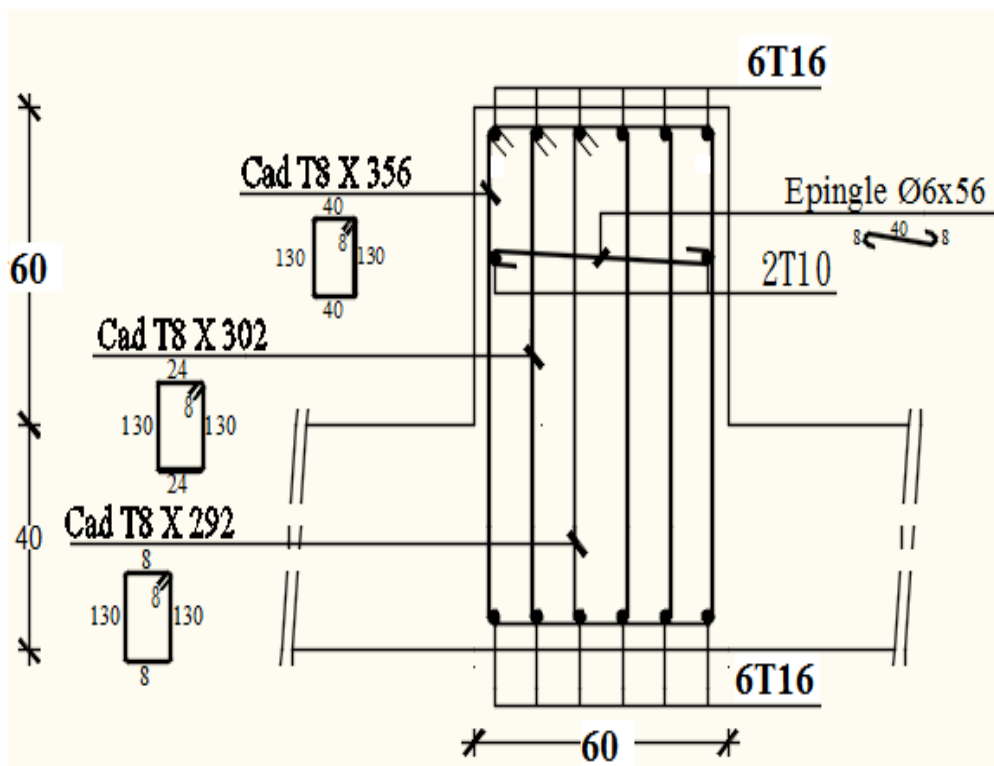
dessin de ferrailage d'une poutre principale en travée.
